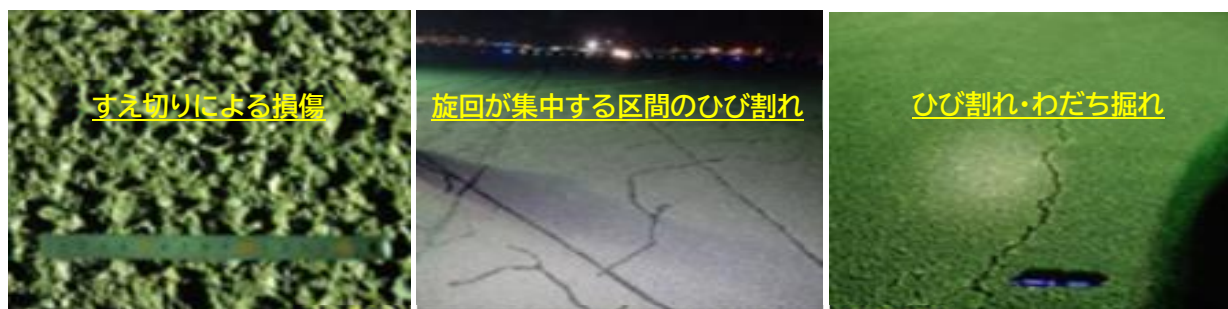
改修前の損傷状況 (AB クロス, 路面状況)
